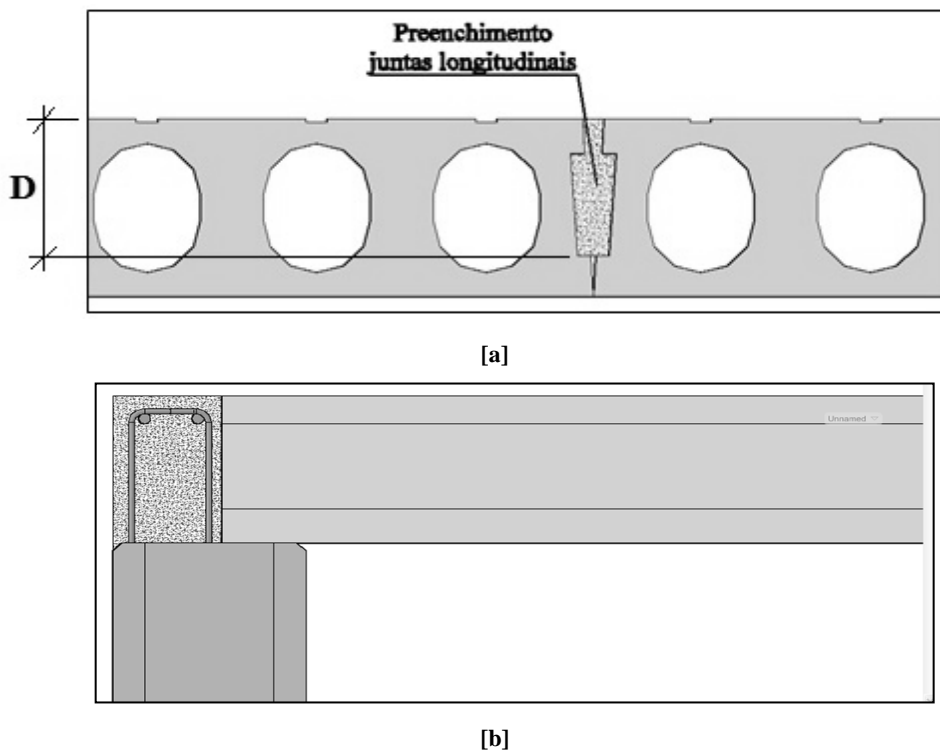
11 – (a) Corte transversal dos painéis e vista da junta preenchida; (b) Corte longitudinal do painel e vista da junta preenchida.
